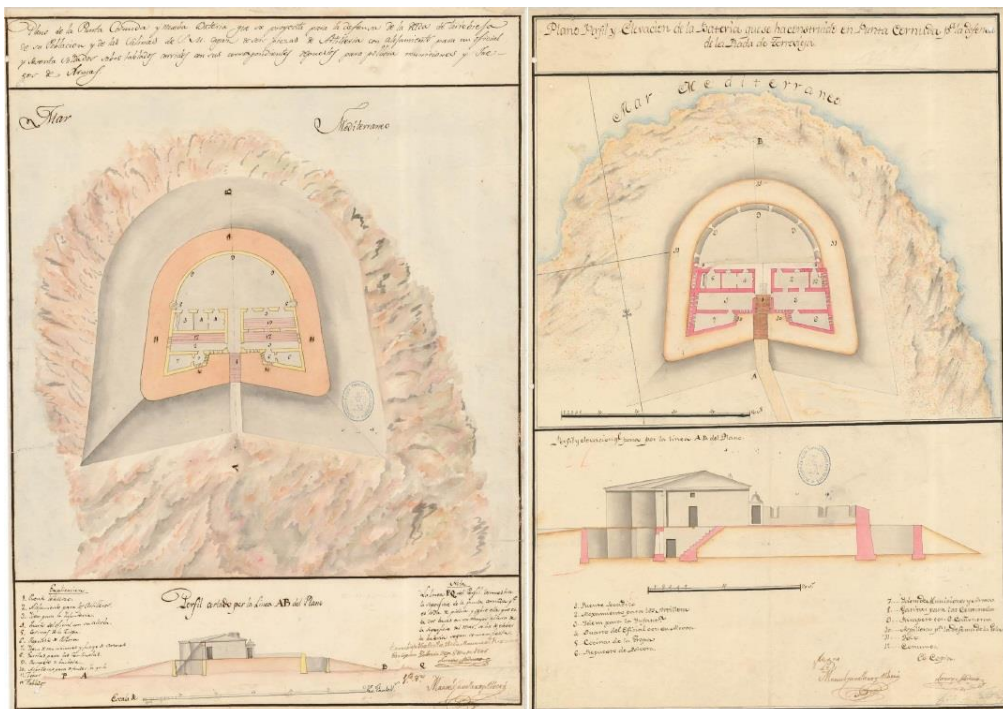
Batería de Punta Cornuda: proyectada (plano 15) y construida (plano 18).
